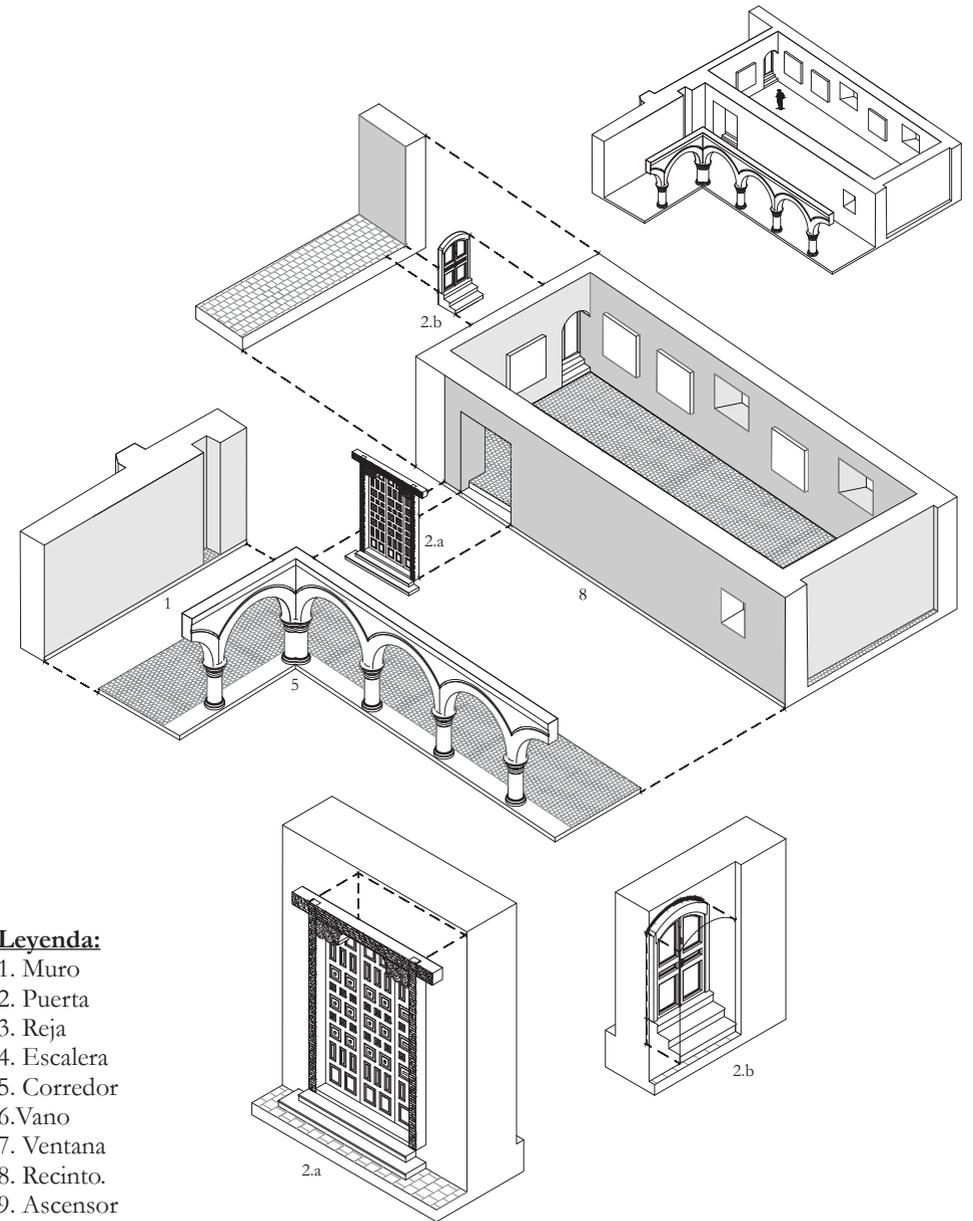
Plano ubicación Pasadizo entre Interiores. (2020). Planimetría. Elaboración propia.
